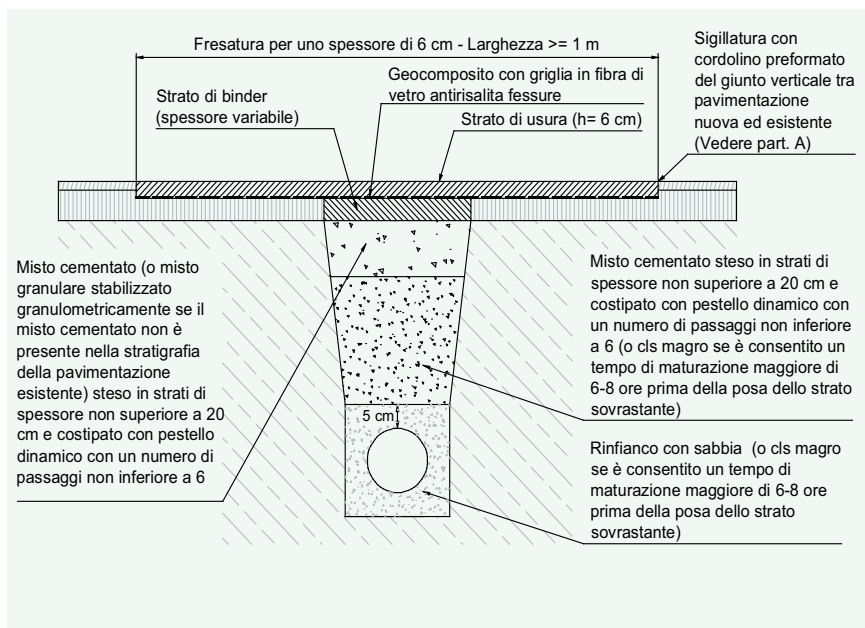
Sezione tipica in sede stradale (caso di pavimentazione in buone condizioni)
